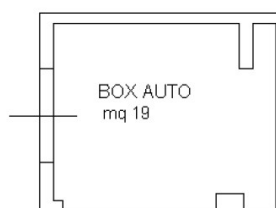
Planimetria del locale box a pianterreno ubicato in via Urbe n° 1 Scala H – interno 1.
